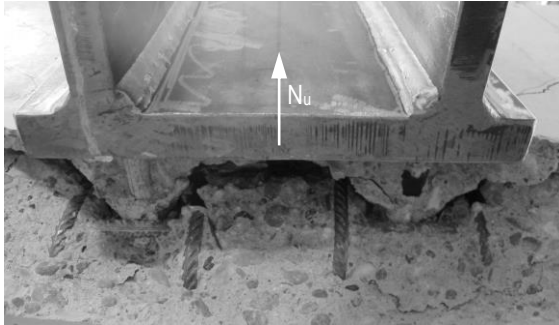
Betonausbruch zwischen der Rückhängebewehrung im Zugbereich einer Ankerplatte nach Kuhlmann, Ruopp (2019)
